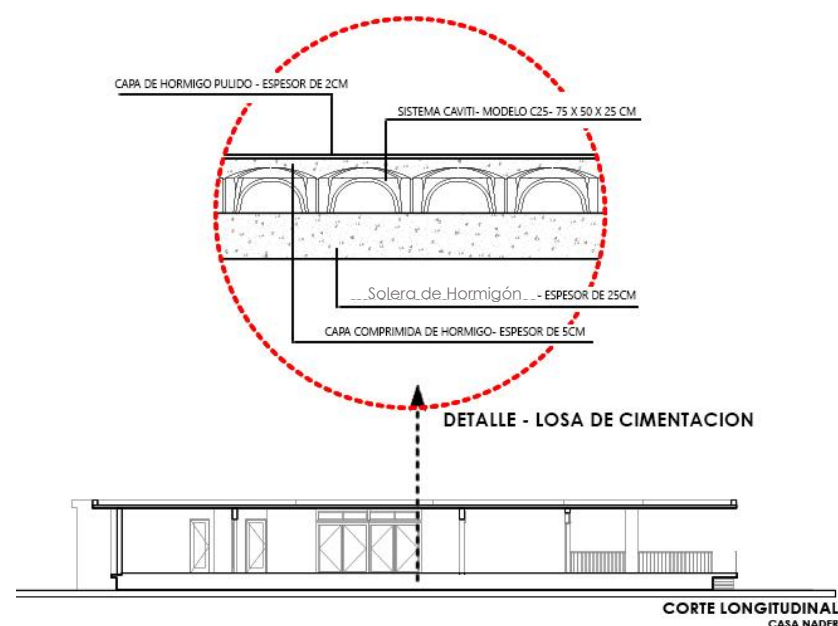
Detalle de sistema Caviti propuesto para solera en modelo Nader. Fuente: Elaboración Propia
